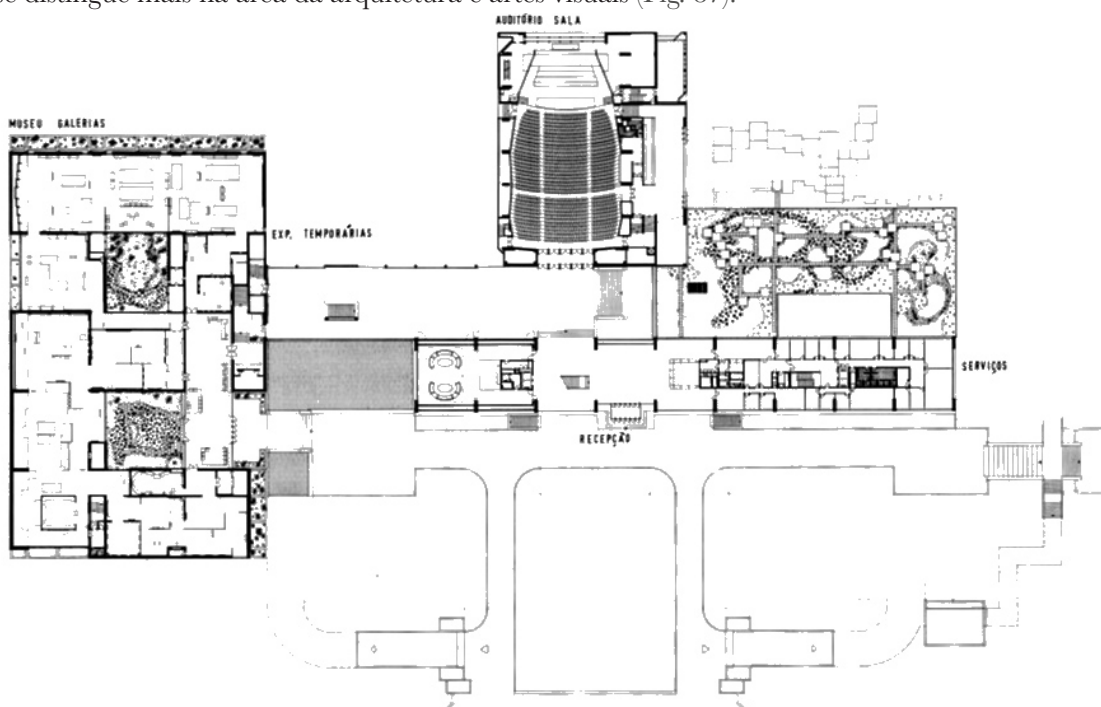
Planta geral da Fundação, Gonçalo Ribeiro Telles
